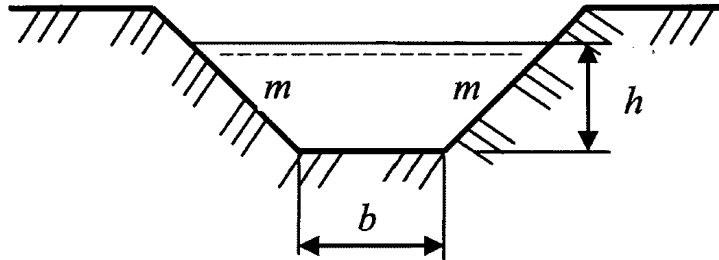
Схема трапецеїдального земляного каналу
